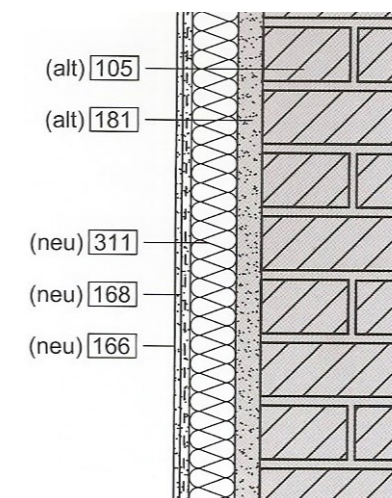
Detail Innendämmung mit Schilfrohrplatten M 1:10
